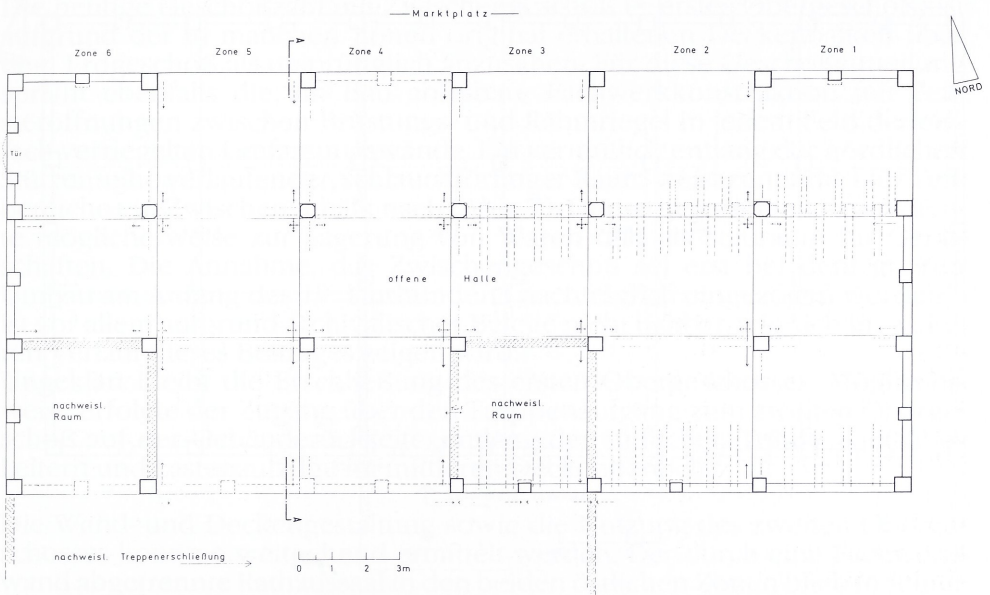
Nürtingen, Rathaus. Ergeschoßgrundriß des spätmittelalterlichen Gebäudes, M 1:220, mit zwei nachweislich abgetrennten Räumen im südlichen Längsschiff.
